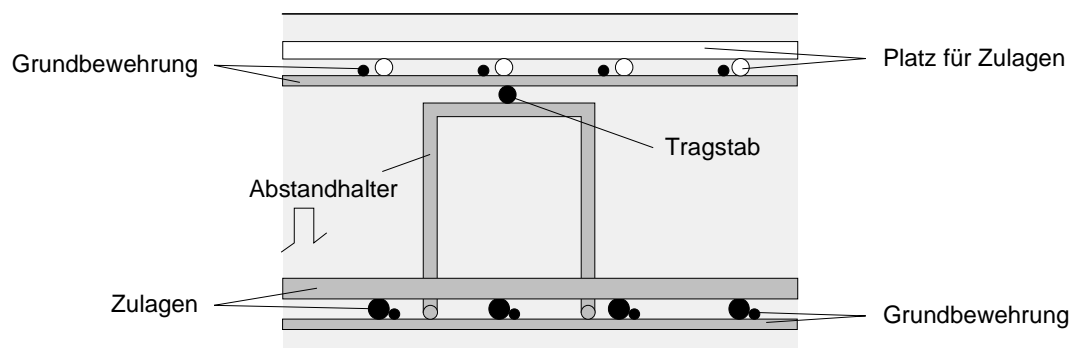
Schnitt durch die Bewehrung bei Verwendung von Abstandhaltern C
